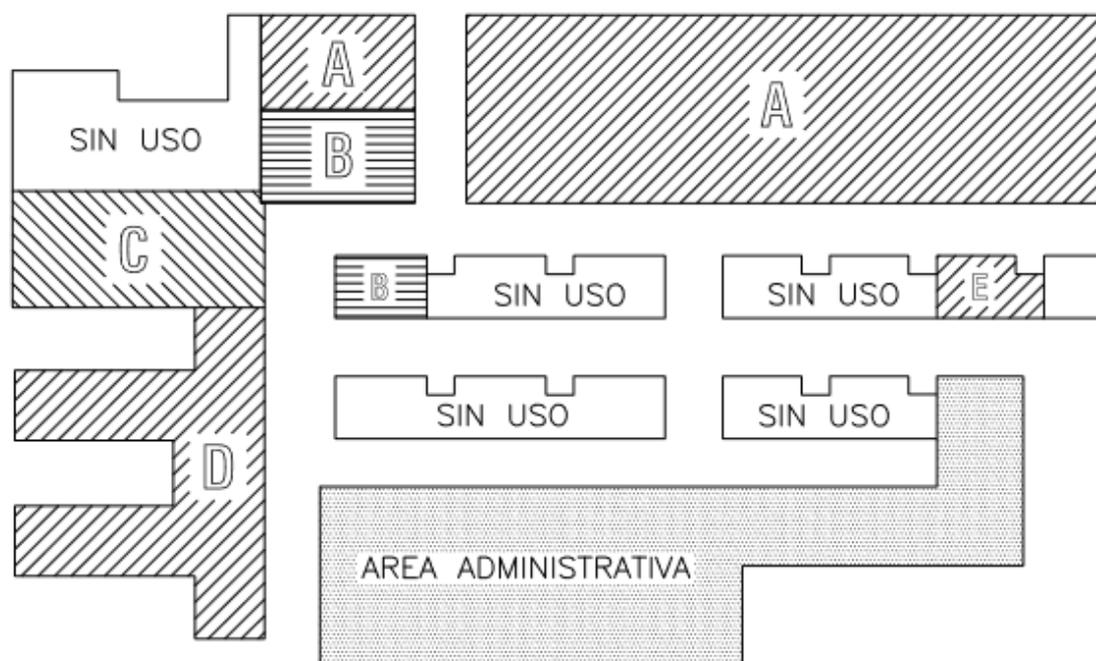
Vista en Planta del centro en sus edificios, oficinas y administración, aulas y talleres
